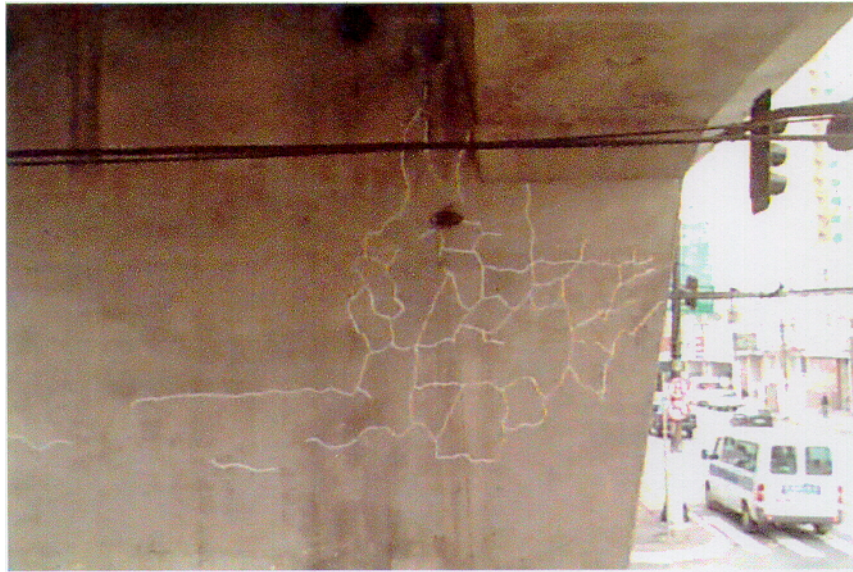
Fissuração principal e secundária do pilar P4, junto à Via 2
